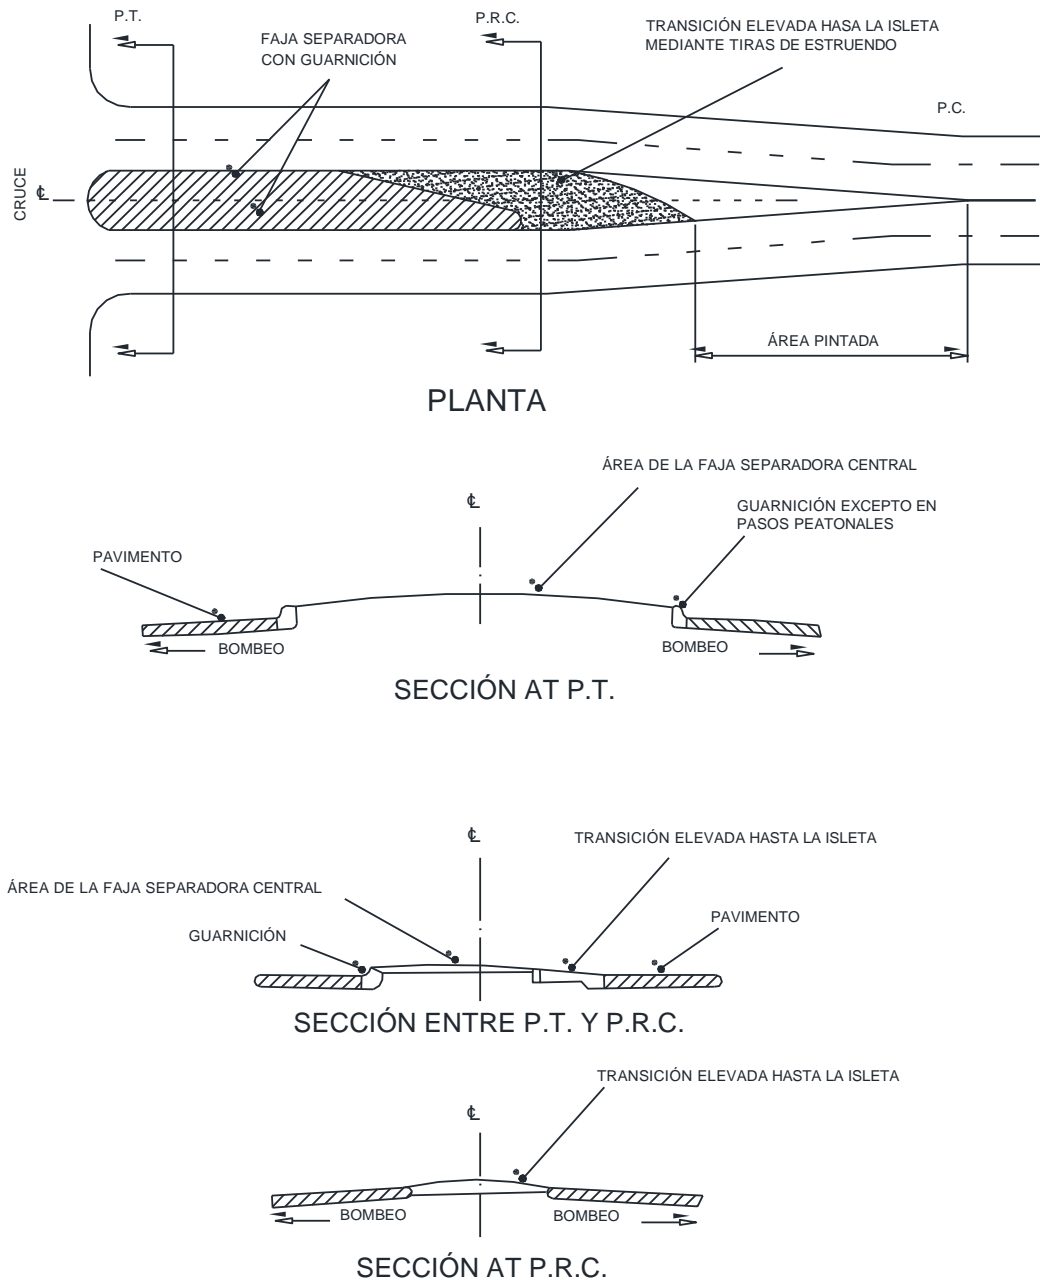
Detalles del proyecto de isletas divisorias
